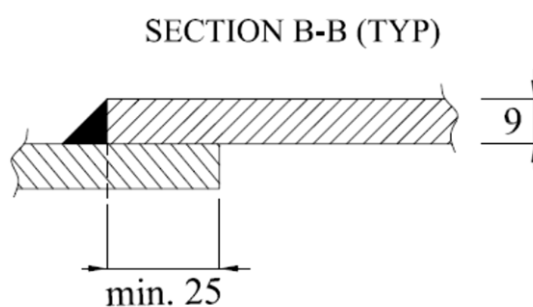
Sezione del collegamento tra due lamiere della piastra di base del serbatoio
